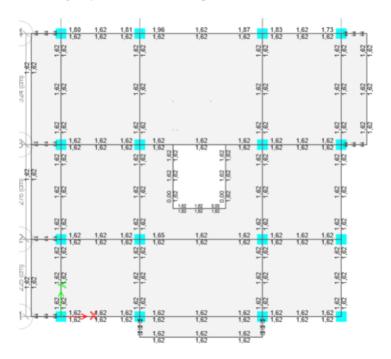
Demanda y capacidad de vigas y columnas en la planta de cubierta
